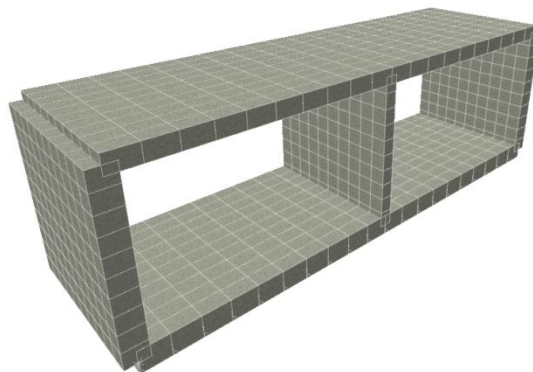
Modelo Box Culvert 1 en SAP 2000.
